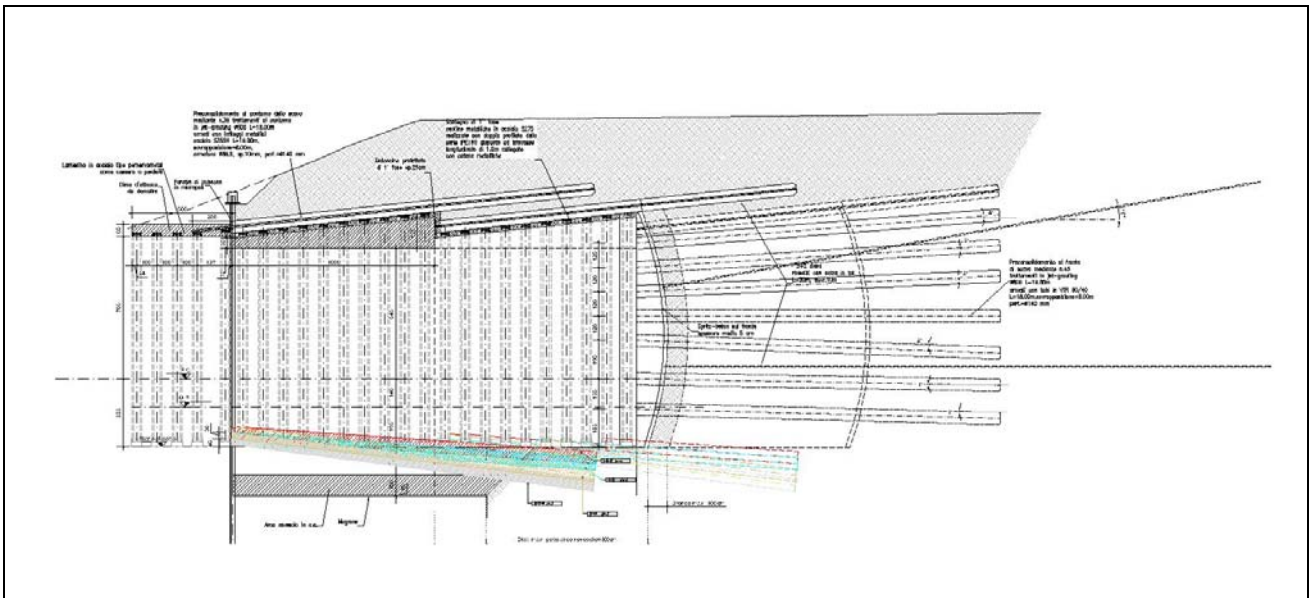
Sezione di scavo tipo GD-C3 Concio d'attacco - Sezione longitudinale
